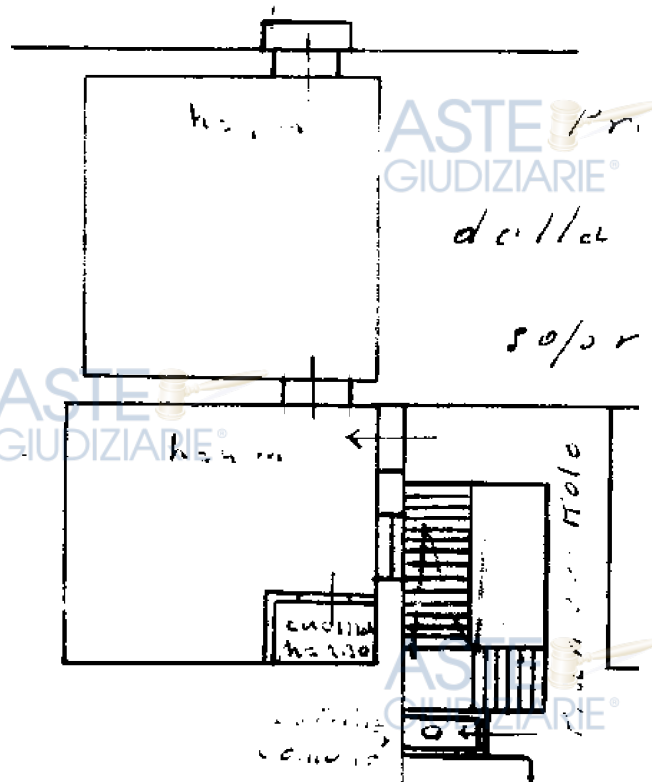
Piano secondo - Stato di fatto e Stralcio Planimetria sub n. 7.
